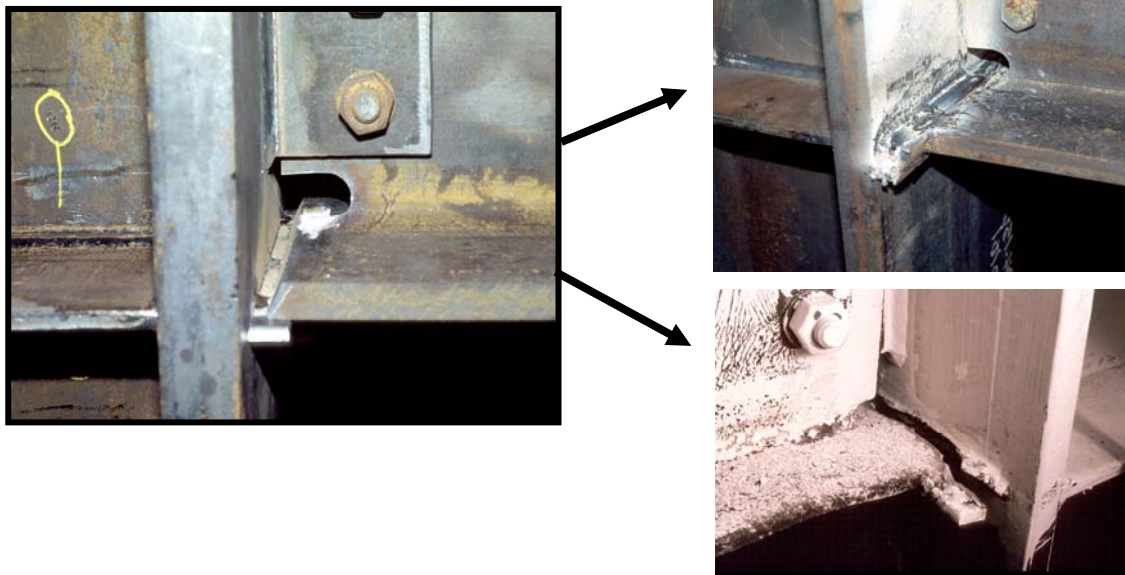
Detalle de Conexión Tipo WUF-W Pre Northridge, la Placa de Respaldo (backing plate) y la falla en el ala inferior. Fuente: Engelhardt, M. D. (2007)
